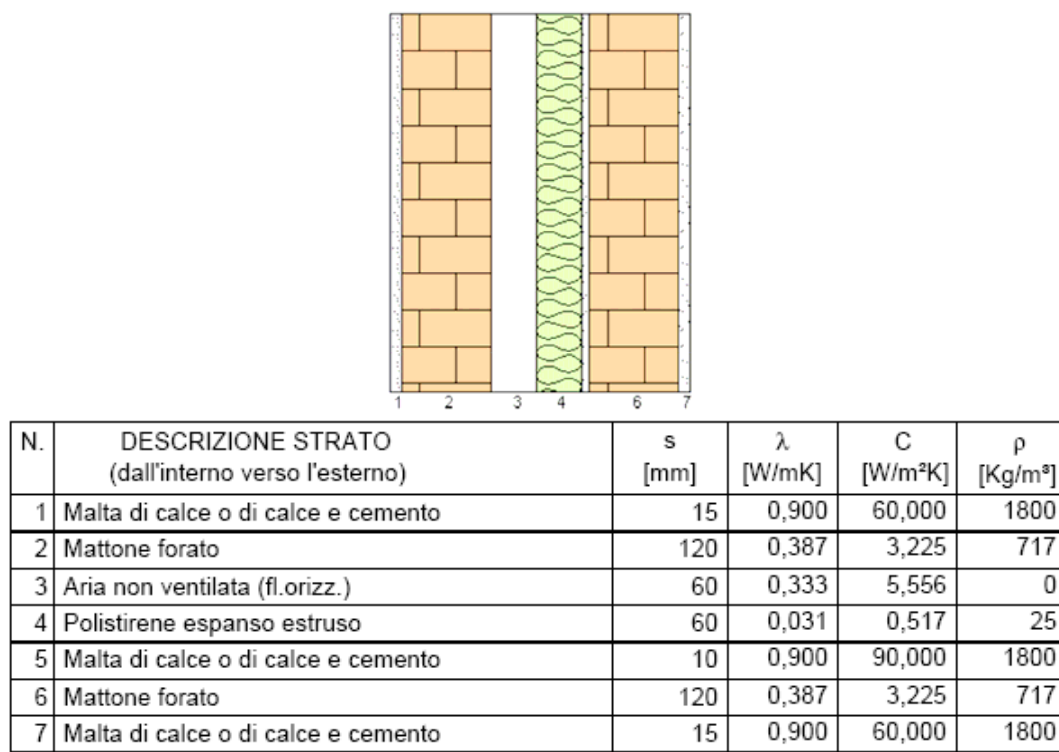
Dettaglio della parete di facciata (sezione verticale).
